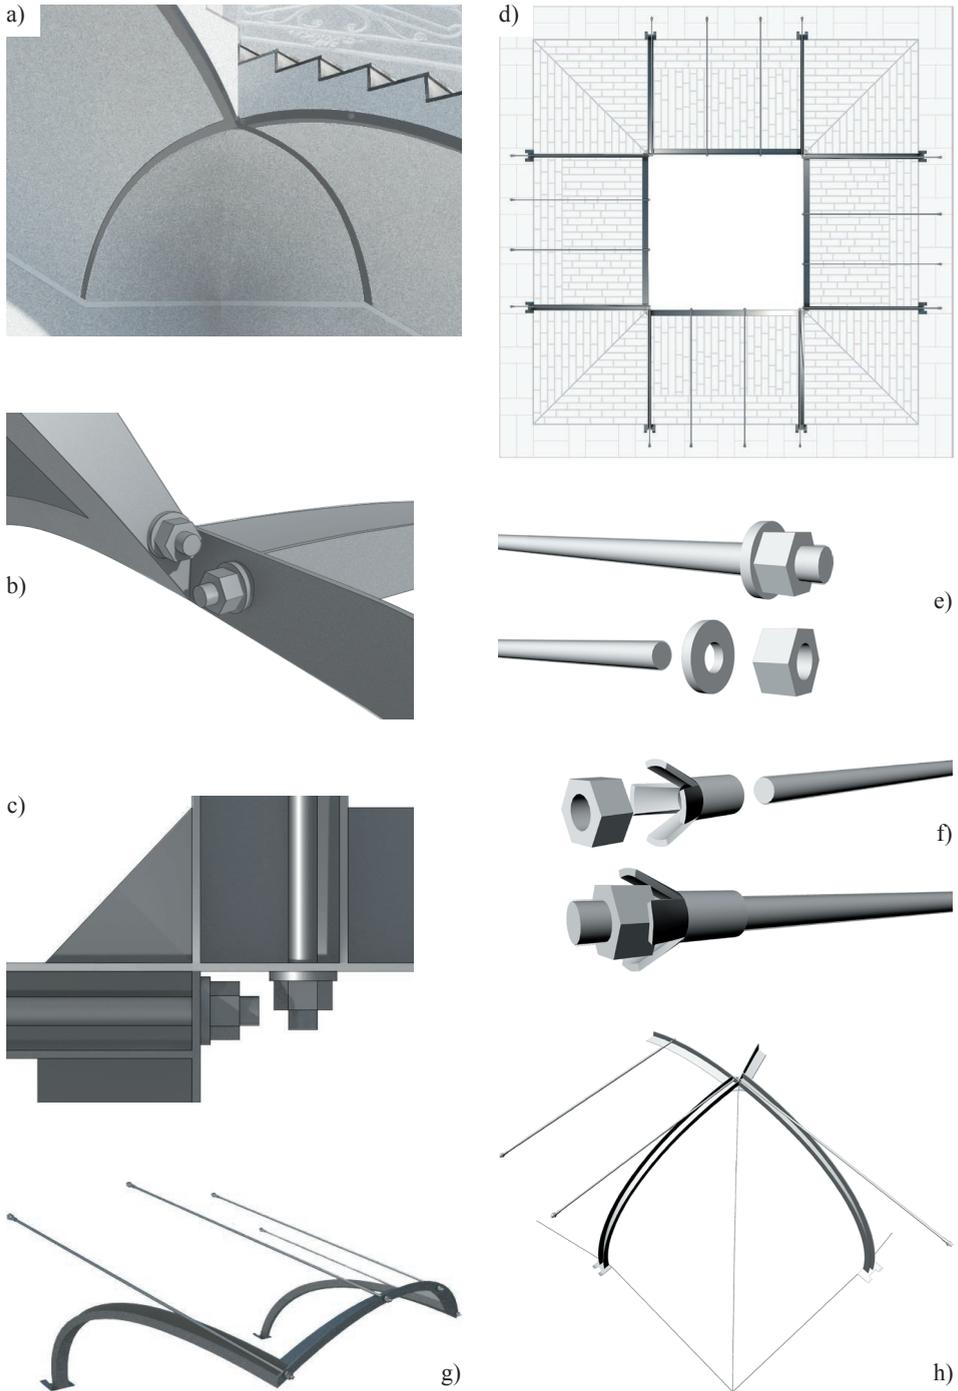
Scala del palazzo Lanzirrotti-Benintende–Caltanissetta: a) assonometria della proposta di intervento; b,c) particolare connessione profilati nel corner; d) pianta profilati; e,f) particolare tenditore; g) vista assonometrica rinforzo rampa; h) vista assonometrica pianerottolo d'angolo.
